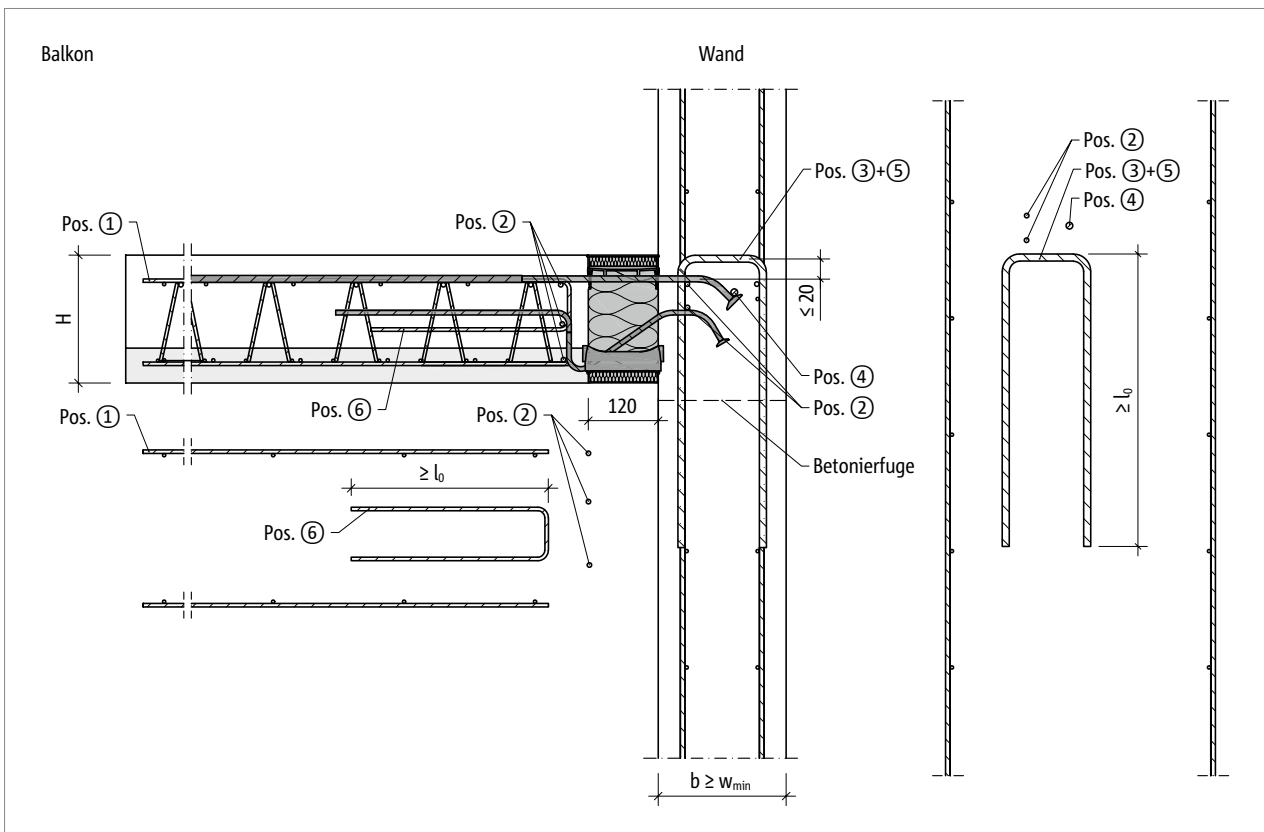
Schöck Isokorb® XT Typ KL-O-F: Bauseitige Bewehrung für Wandanschluss nach unten
